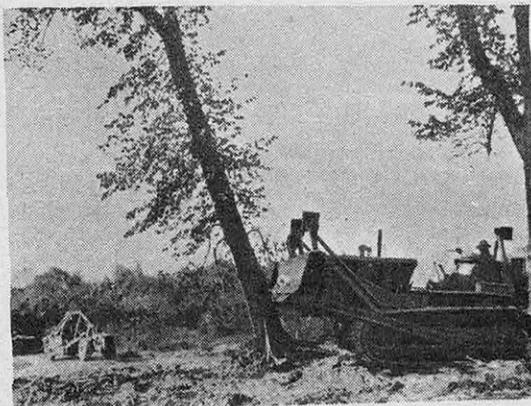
ET 5. — ABATAGE D'UN ARBRE PAR POUSSÉE (A GAUCHE) ET PAR ARRACHAGE (A DROITE) (PHOTO LE TOURNEAU)
